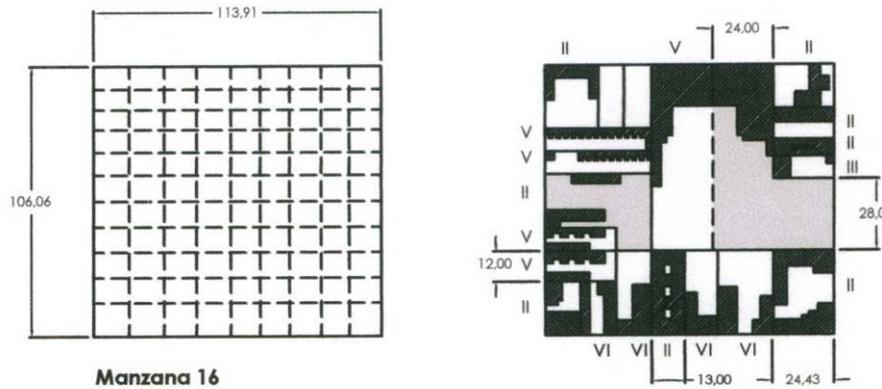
AGRUPACIÓN DE PARCELAS PARA ALOJAR ESTRUCTURAS MÁS GRANDES, MANTENIENDO TIPOS TRADICIONALES EN EL PERÍMETRO INFERIOR DE LA MANZANA.
